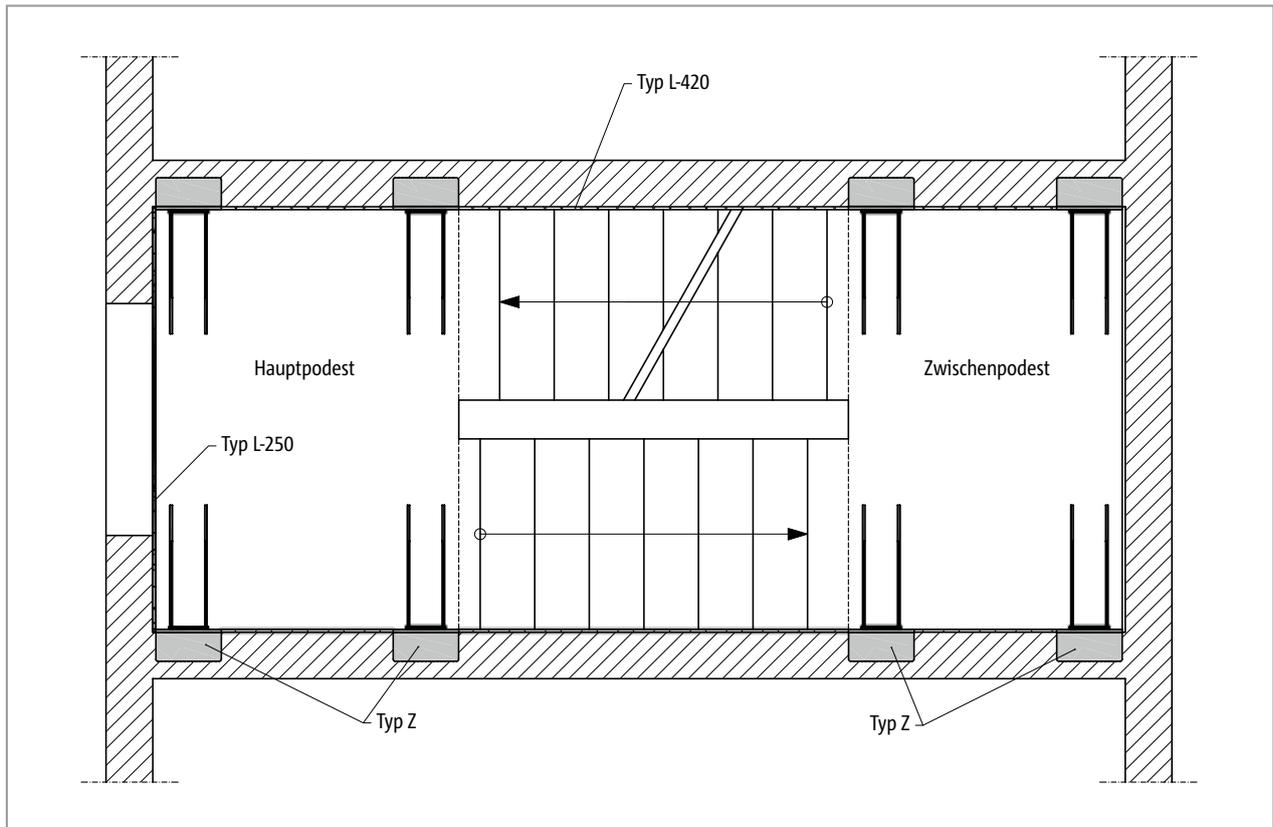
Schöck Tronsole® Typ Z: Elementanordnung im Grundriss
